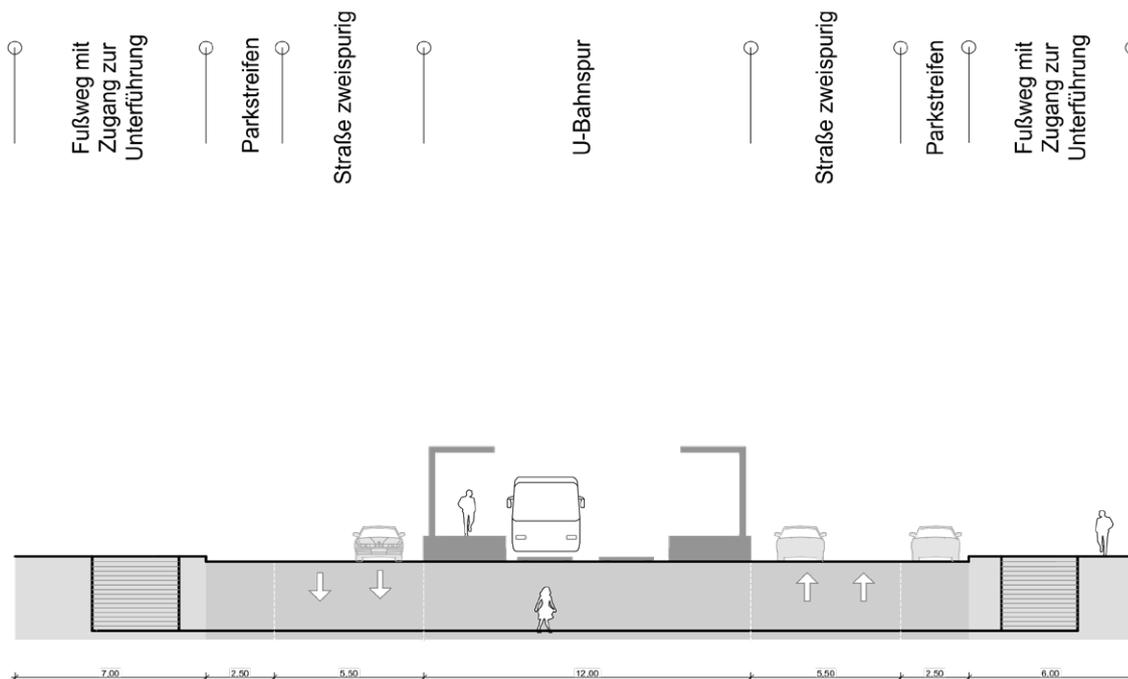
Wasenstraße Bestand Schnitt (Eigene Darstellung)
